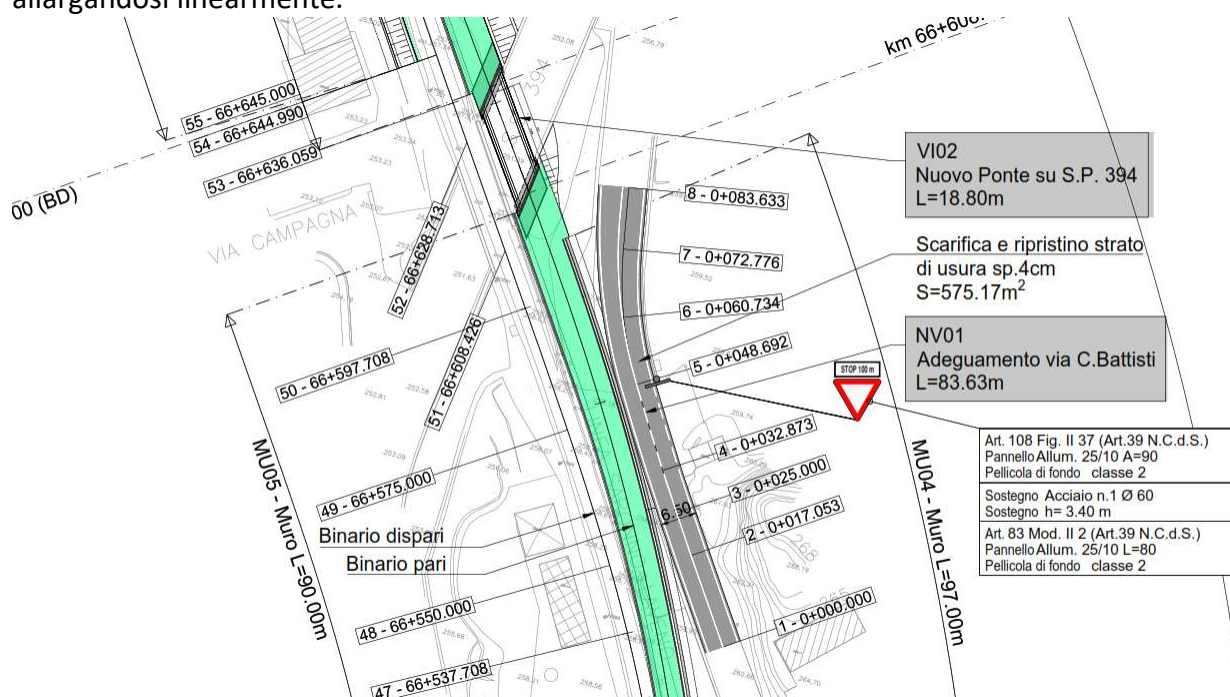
Planimetria di progetto adeguamento via Battisti.
